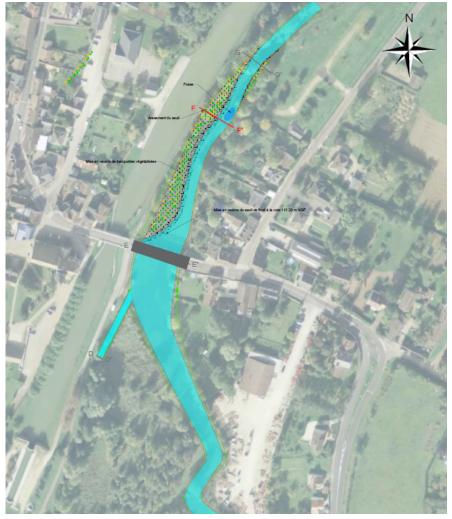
Seuil du camping à Montbouy – plan de masse du projet – LOING AMONT
